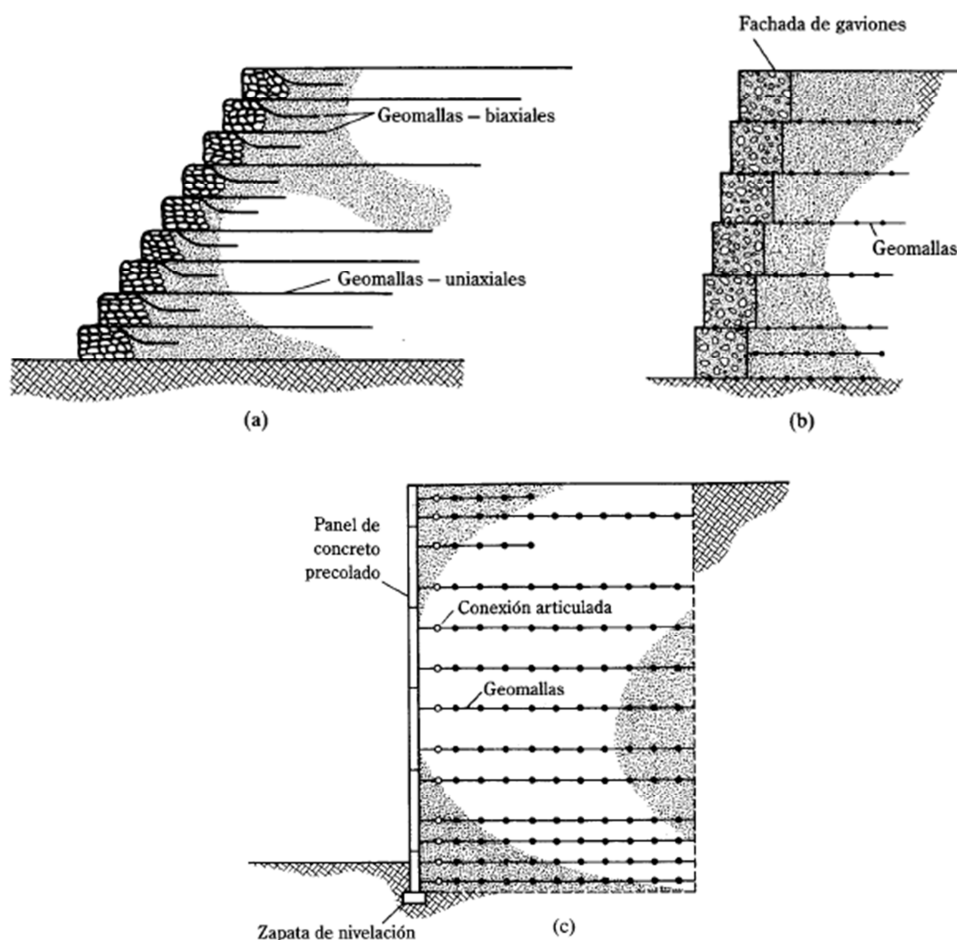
Diagramas típicos de muros de retención con refuerzo de geomallas: (a) muro con geomallas todo alrededor; (b) muro con fachada de gaviones; (c) muro con fachada de paneles de concreto [10].
